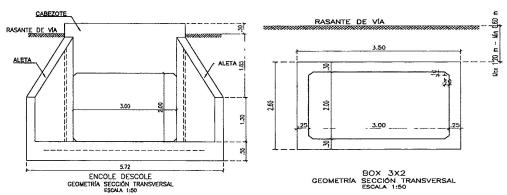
Detalle transversal del descole de box culvert de  $3x2^{12}$ .
